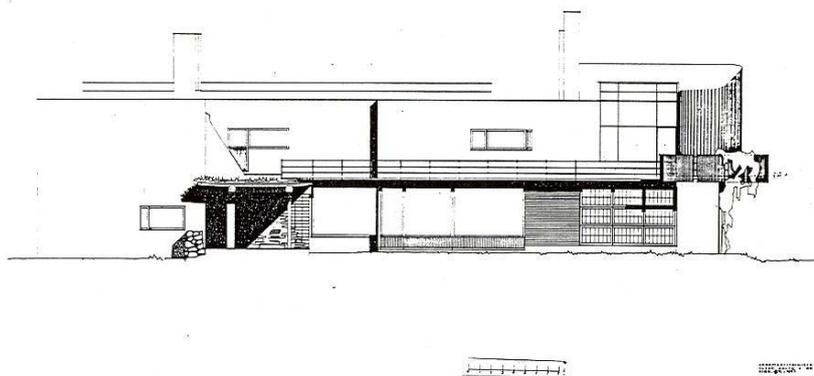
Alzado de la versión definitiva. Utiliza elementos de fachada que enfatizan la componente horizontal. Croquis 84-447
